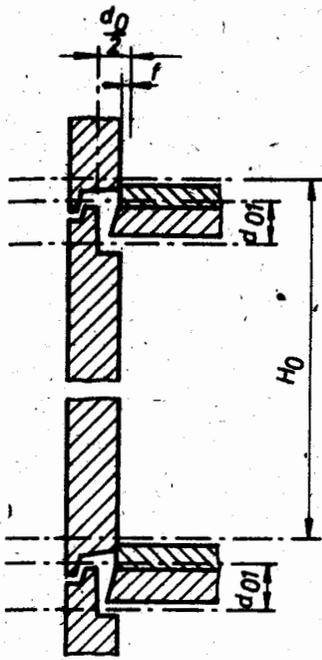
Lage der Außenwand mehrgeschossiger Skelettkonstruktionen
